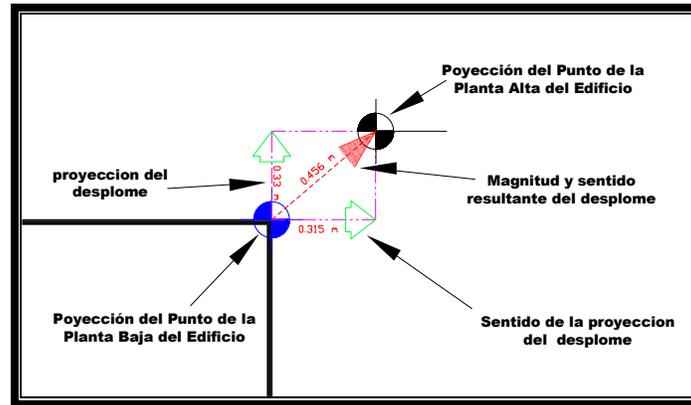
Proyección en planta de los puntos de la parte alta y baja del edificio, con su desplome.
